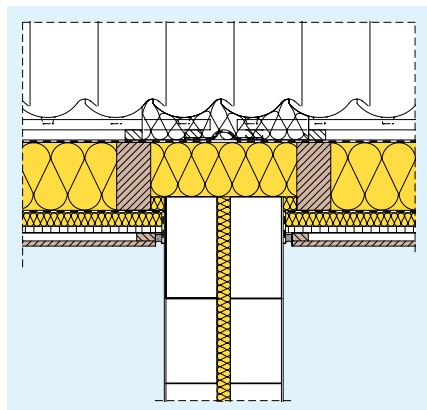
Dachanschluss bei einer zweischaligen Haustrennwand ohne durchlaufende Dachlatten (Brandschutz der LBO beachten)
